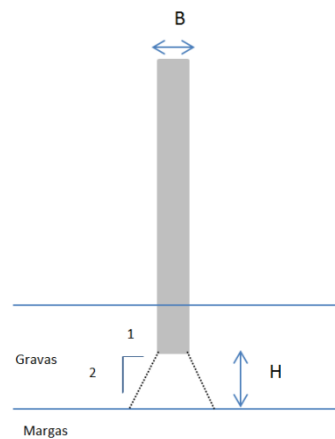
Pilote perforado con sección no circular (elemento portante (barrette))
